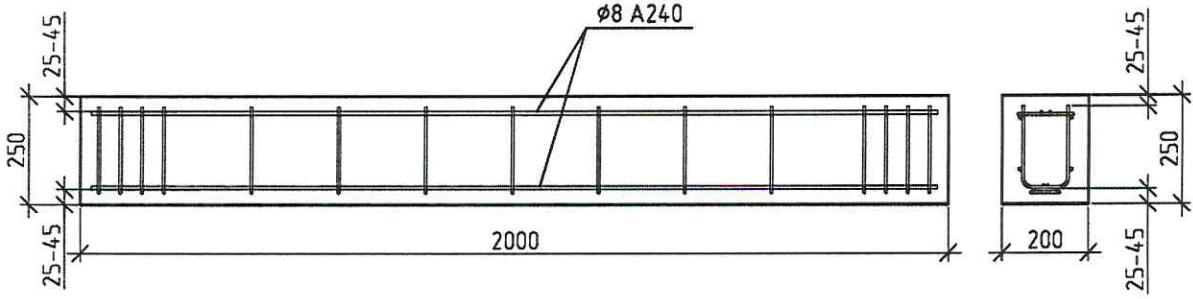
Схема армирования перемычки с плоским каркасом
